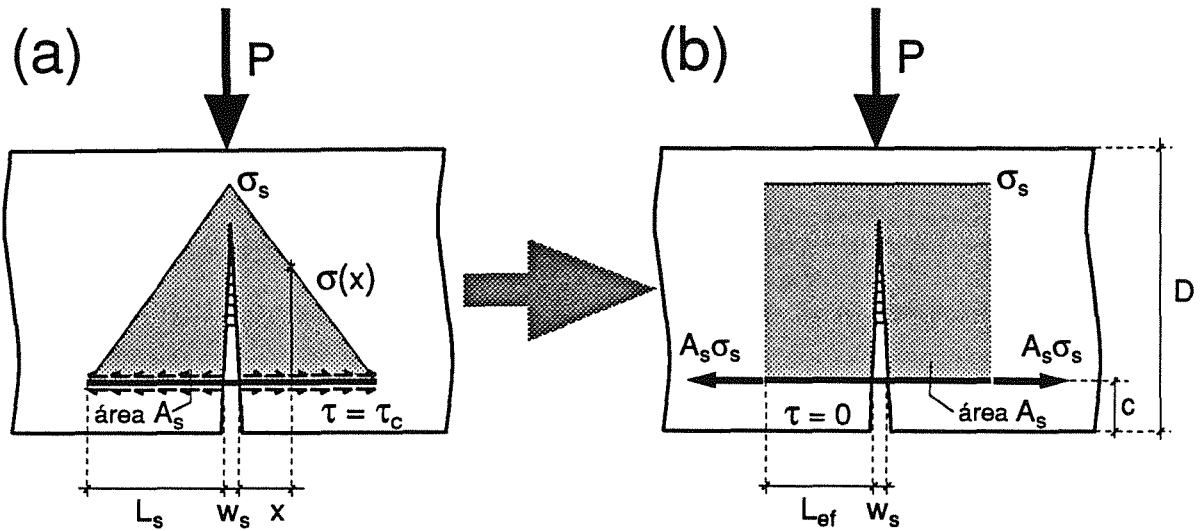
Equivalencia mecánica entre una barra de acero —embebida en una viga de hormigón— con adherencia crítica constante (a) y una barra anclada con deslizamiento libre (b).
